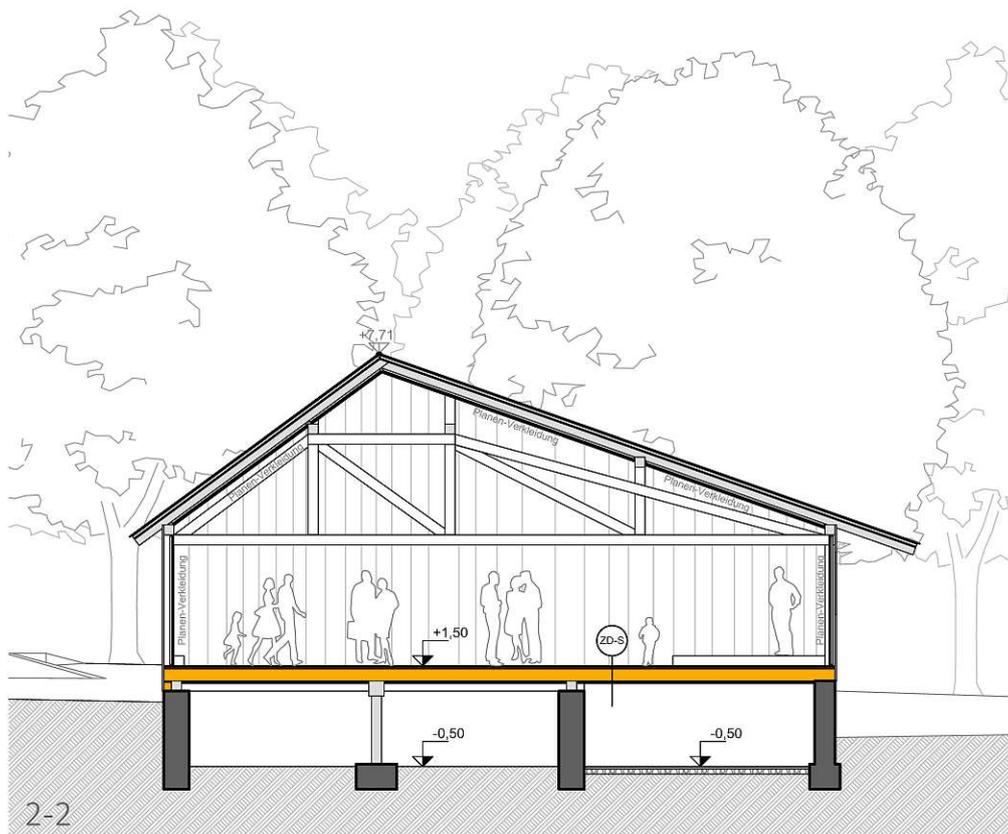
Schnitt Sägewerk 2-2 – Entwurf, Maßstab 1:150.
